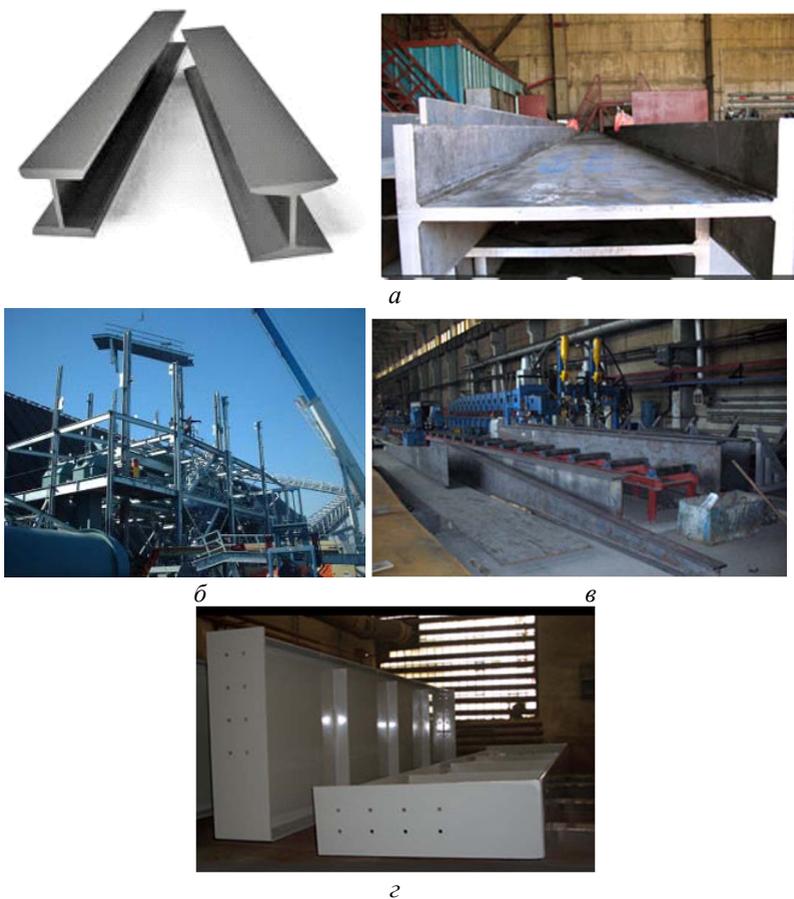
Балки: а – двутавровые балки; б – конструкции из двутавровых балок; в – балка переменного сечения; г – подкрановые балки
